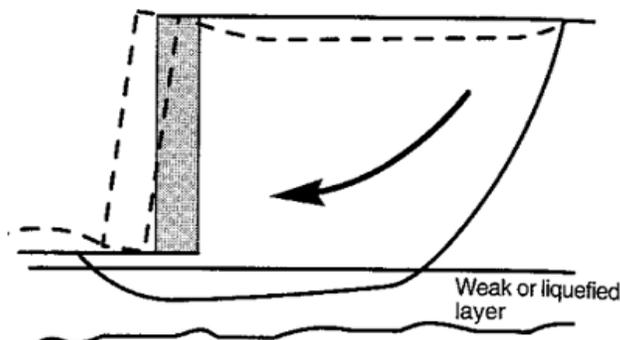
Rupture par instabilité d'ensemble ou grand glissement.
